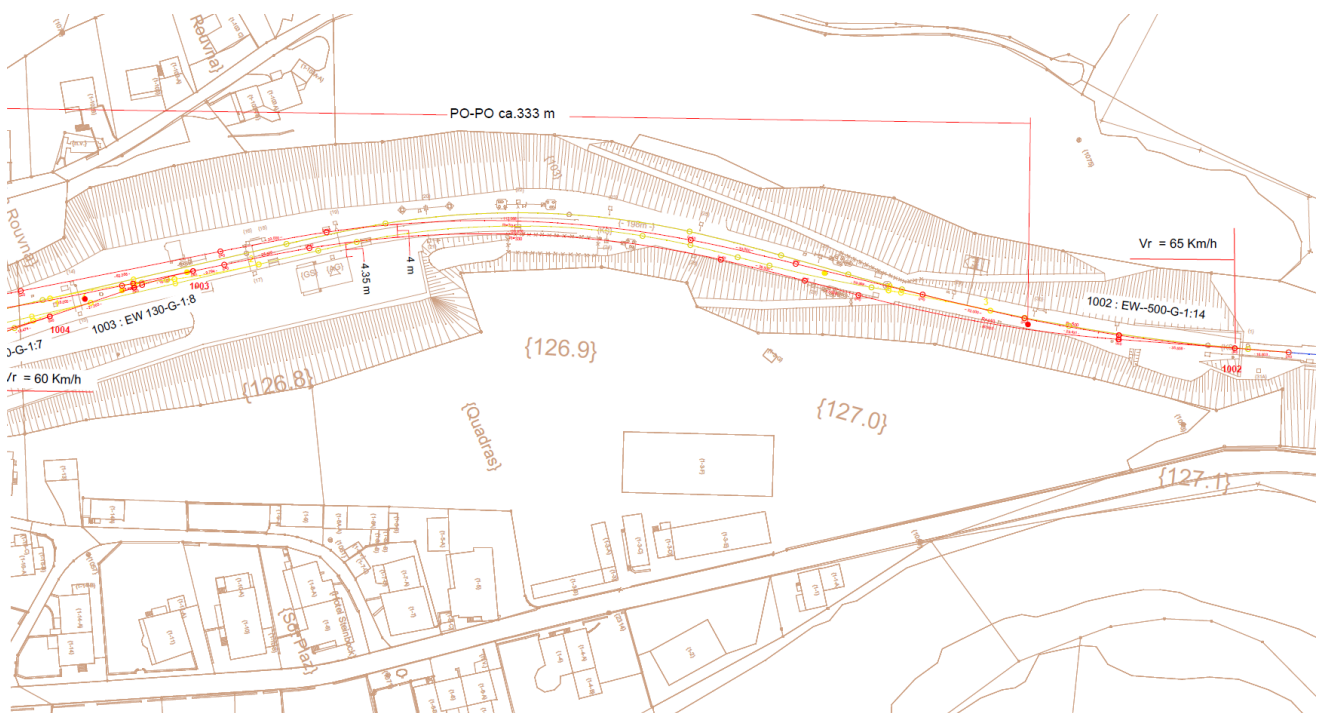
Auszug Plan Bahnhofumbau Susch im Bereich der Gärtnereiparzelle (rot = neue Gleisführung, gelb = bestehende Gleislage), Variante 7.3, 13.10.2023
